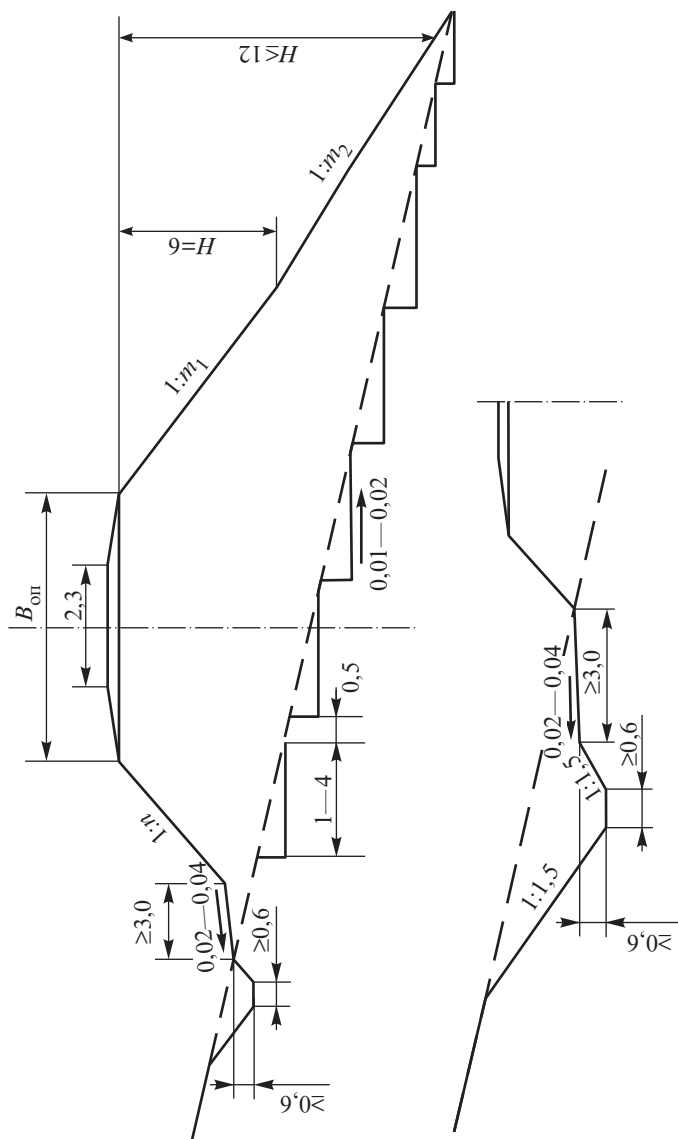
Поперечный профиль насыпи на косогоре крутизной от 1:5 до 1:3:
